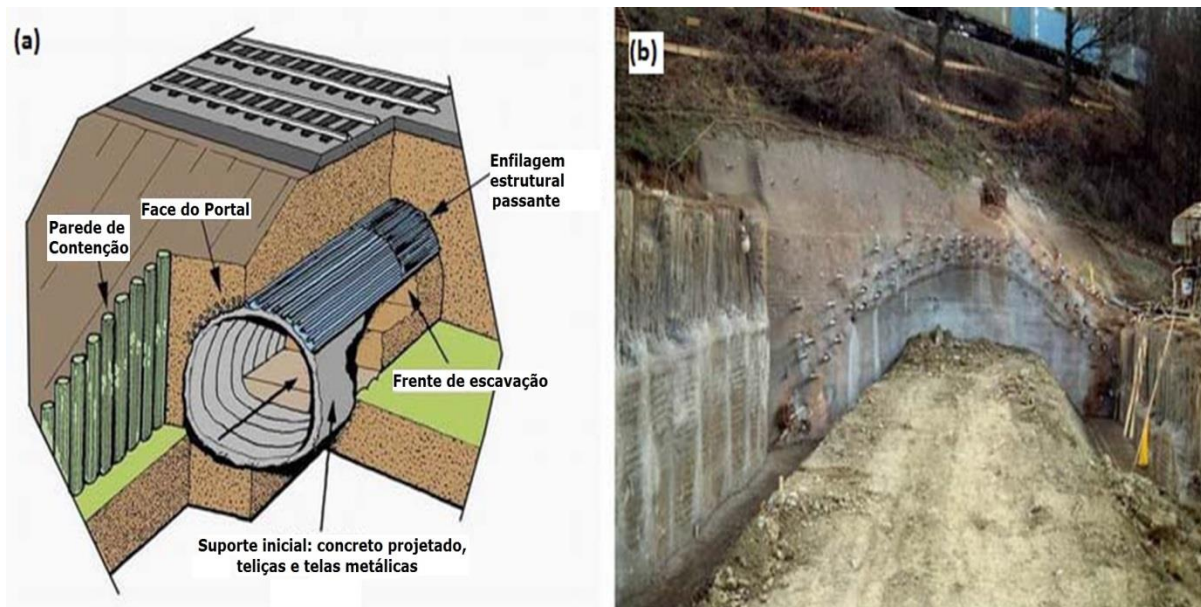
Método construtivo denominado enfilagem estrutural passante. (a) ilustração da instalação sob aterro da ferrovia; (b) vista da execução da obra (modificado de Sauer, 2004).
